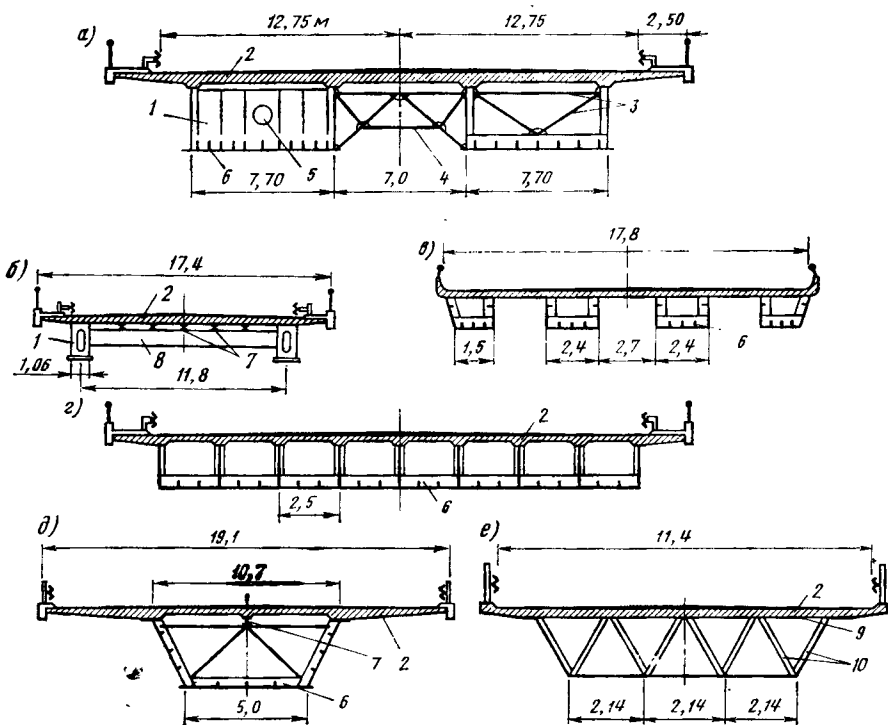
Поперечные сечения пролетных строений с полуоткрытым и замкнутым контурами и железобетонной плитой в проезжей части:
